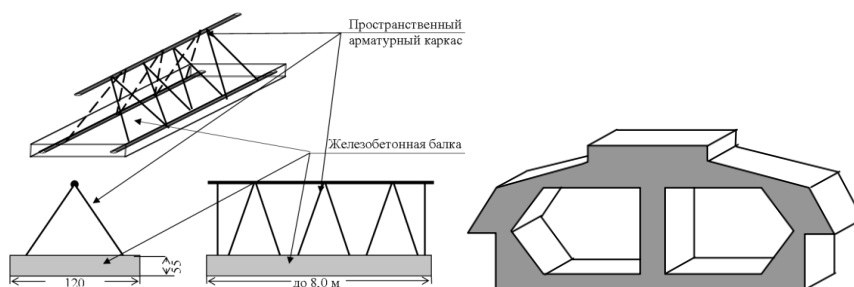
Монтажний залізобетонний прогон та керамзитобетонний пустотний блок збірно-монолітного перекриття «ALBERT»
